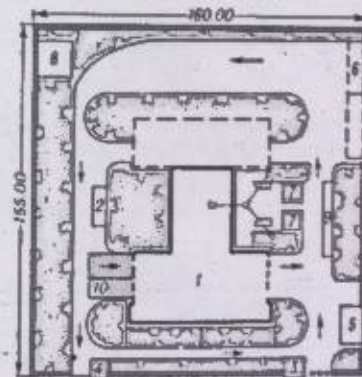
Генеральный план типового троллейбусного депо на 50—100 машин: 1 — главный корпус; 2 — склад горюче-смазочных материалов; 3 — проходная; 4 — контрольная; 5 — закрытая стоянка на 3 автомобиля; 6 — склады; 7 — площадка для топлива; 8 — резервная площадка; 9 — открытая площадка для мойки троллейбусов; 10 — бетонированная площадка для стоянки.
